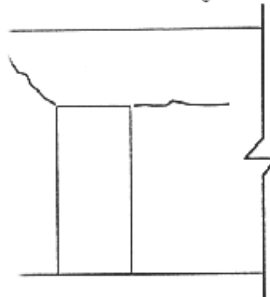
FISSURAS nos cantos da porta Falta de Verga
